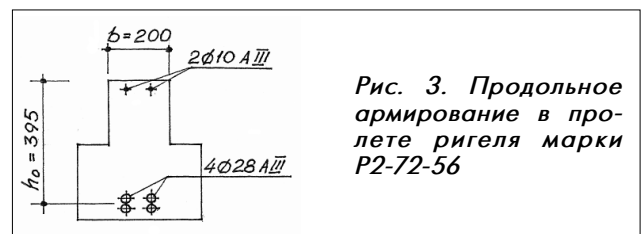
Продольное армирование в пролете ригеля марки P2-72-56
